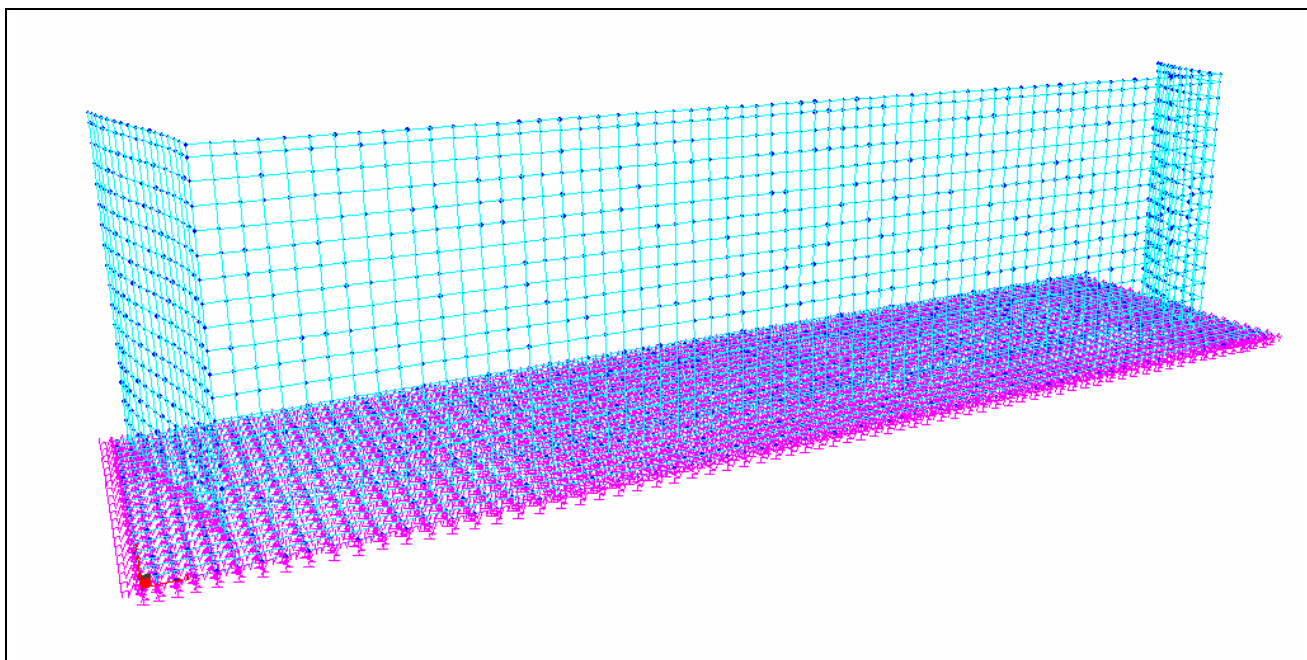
rappresentazione assonometrica del modello di calcolo della spalla.
